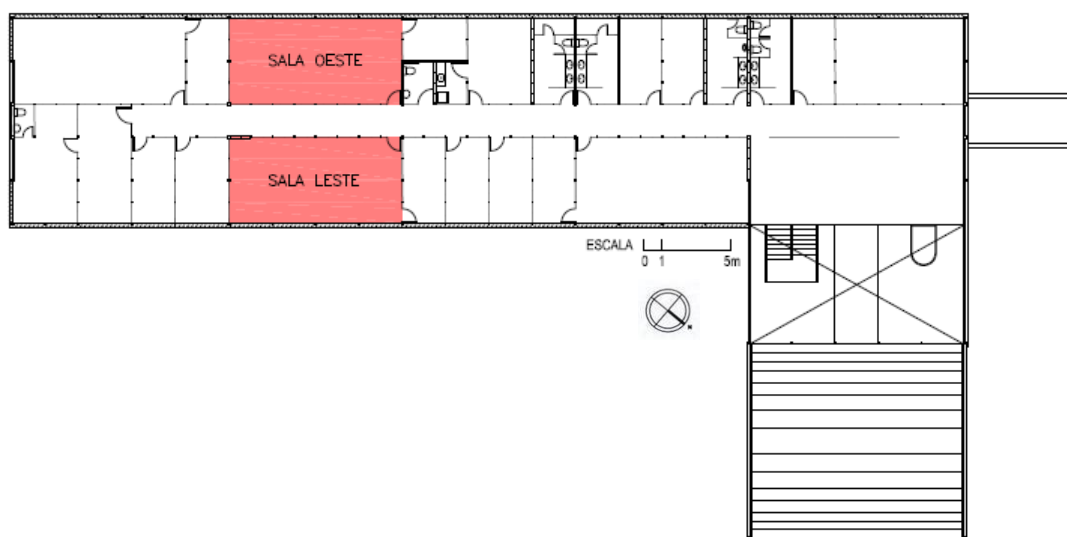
Planta esquemática do segundo pavimento com a localização das salas para a realização das medições.
